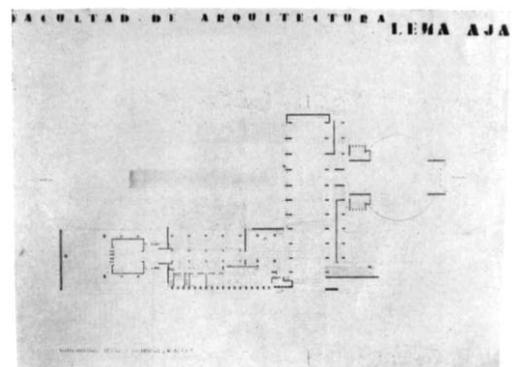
Proyecto ganador del Concurso para la Facultad de Arquitectura. Planta Nivel 4
